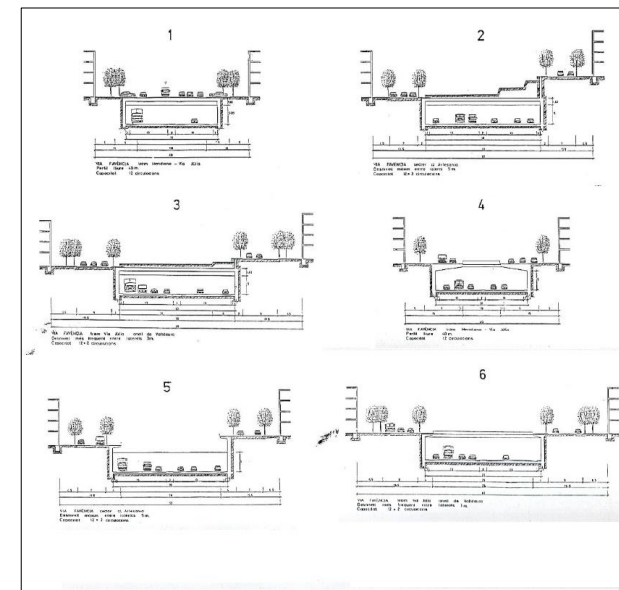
Secciones tipo del proyecto de Ribas Piera de 1984. Ayto. de Barcelona, 1984.
